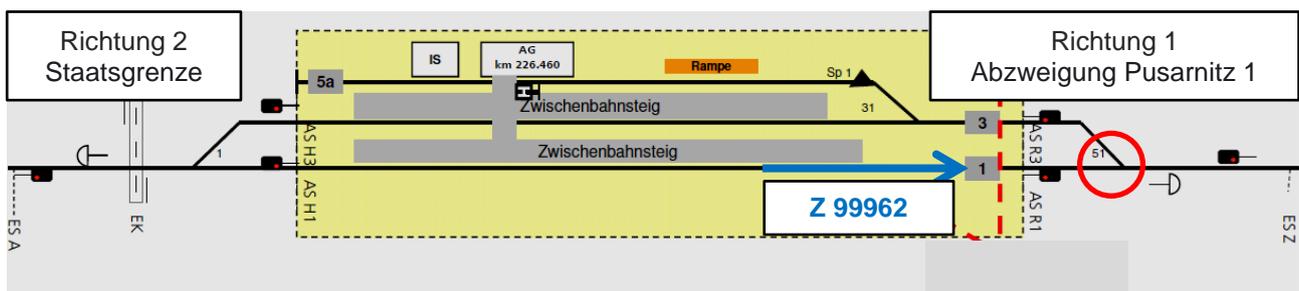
Lageplanskizze Bf Steinfeld im Drautal (Quelle IM)
